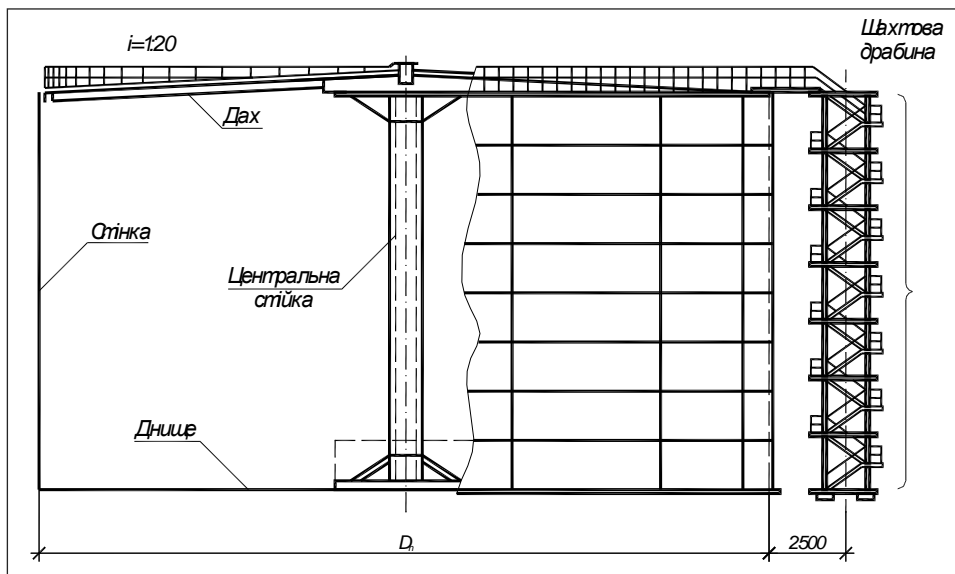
Фасад і розріз вертикального циліндричного резервуара
